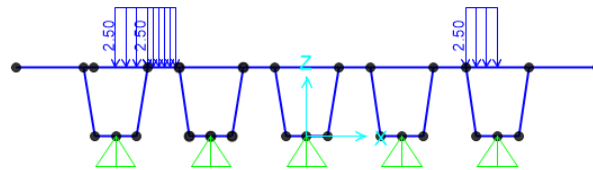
Assegnazione carichi su modello agli E.F. - Schema 1 - Disposizione 2 - Tandem (Q1-2-1)
